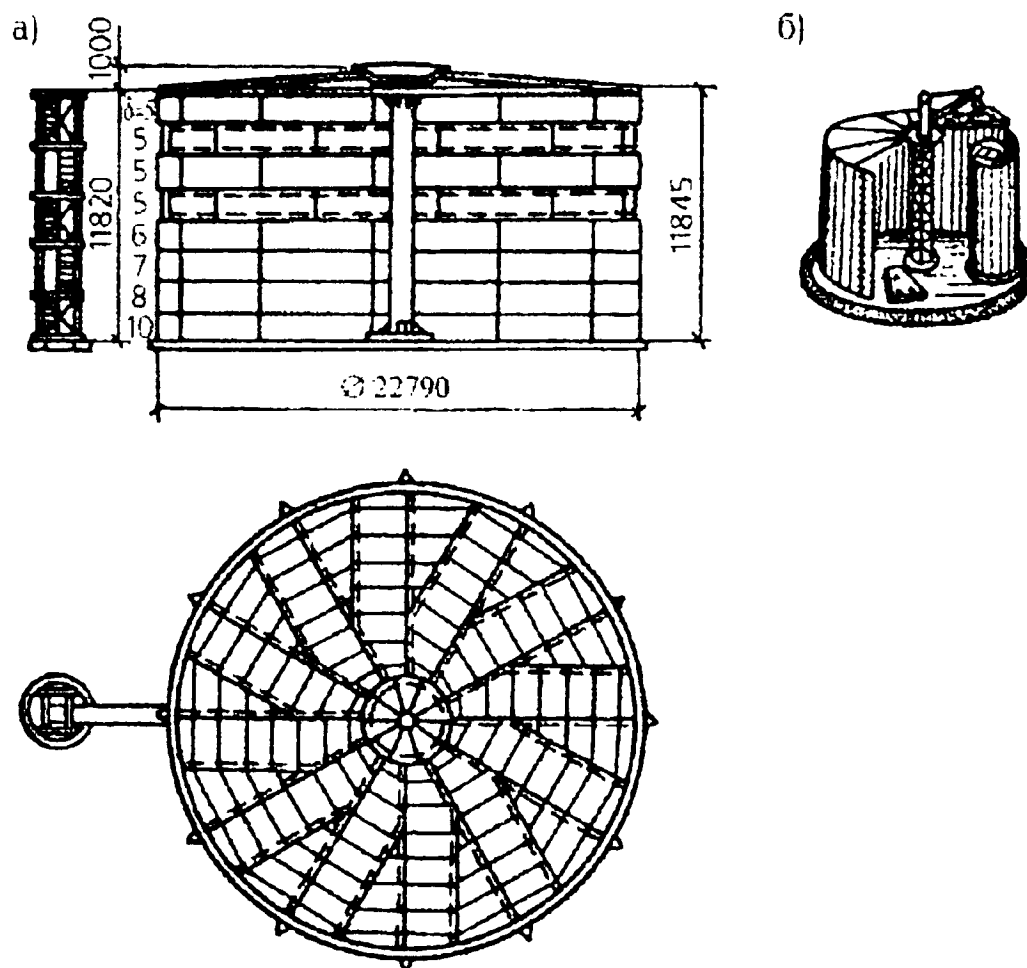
Вертикальный цилиндрический резервуар низкого давления: а - конструктивная схема; б - схема монтажа
